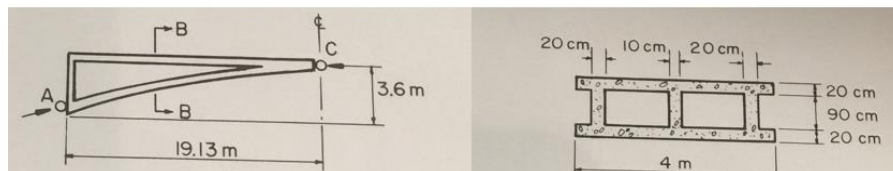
Ponte Stauffacher- representação da fachada em alvenaria, arco de concreto, articulações, paredes transversais e tabuleiro
